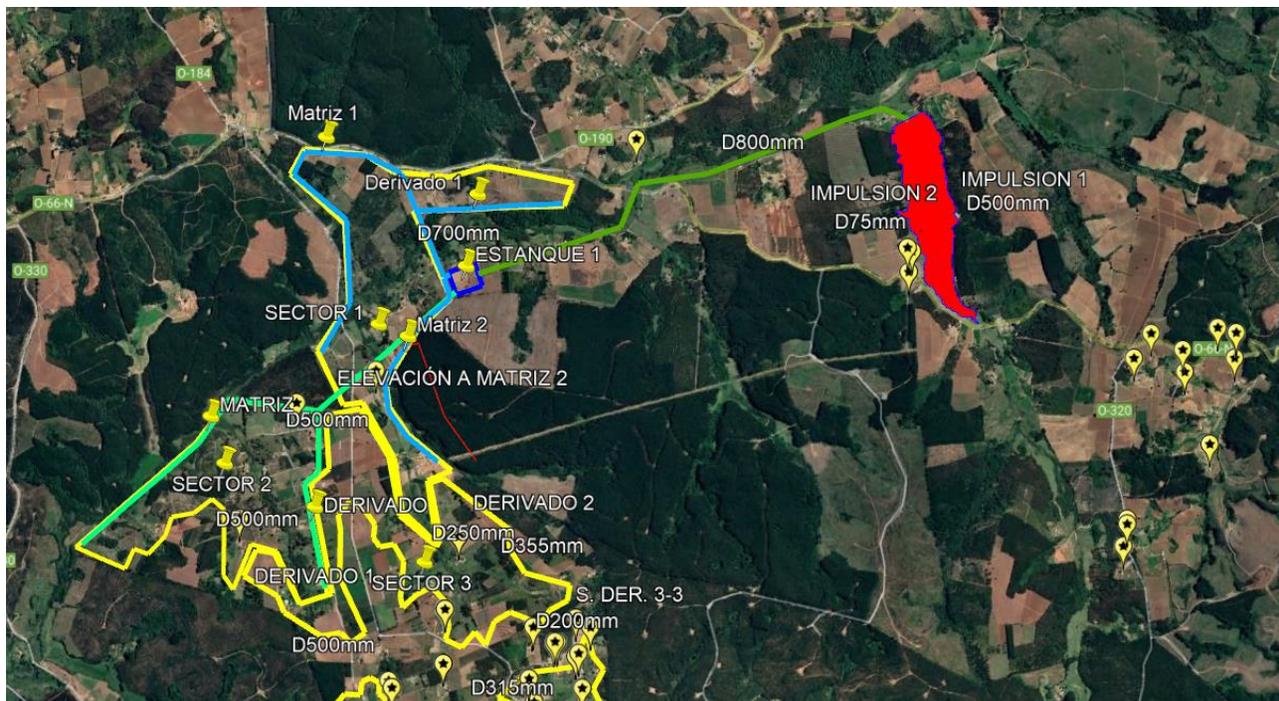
Planta proyecto embalse Rahuil alternativo
